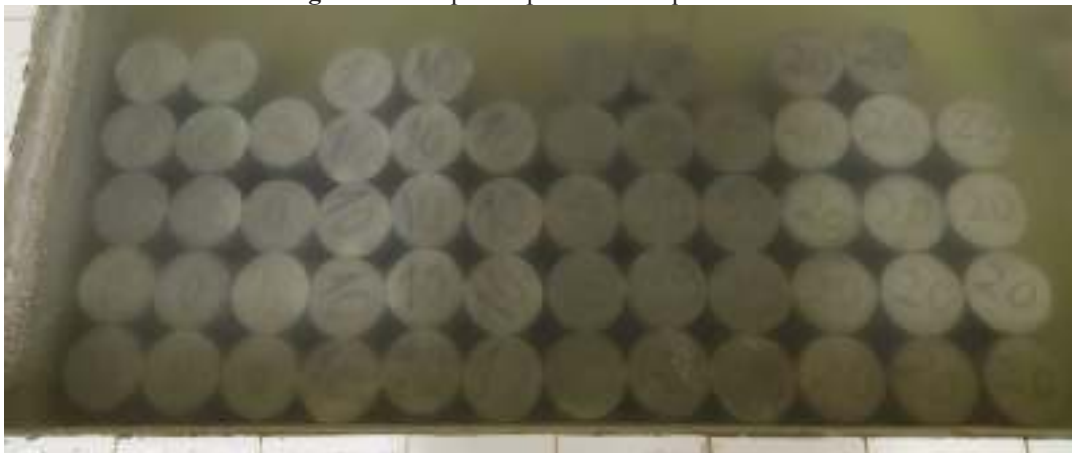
Corpos de prova do traço de referência desmoldados após 24 horas da moldagem.
